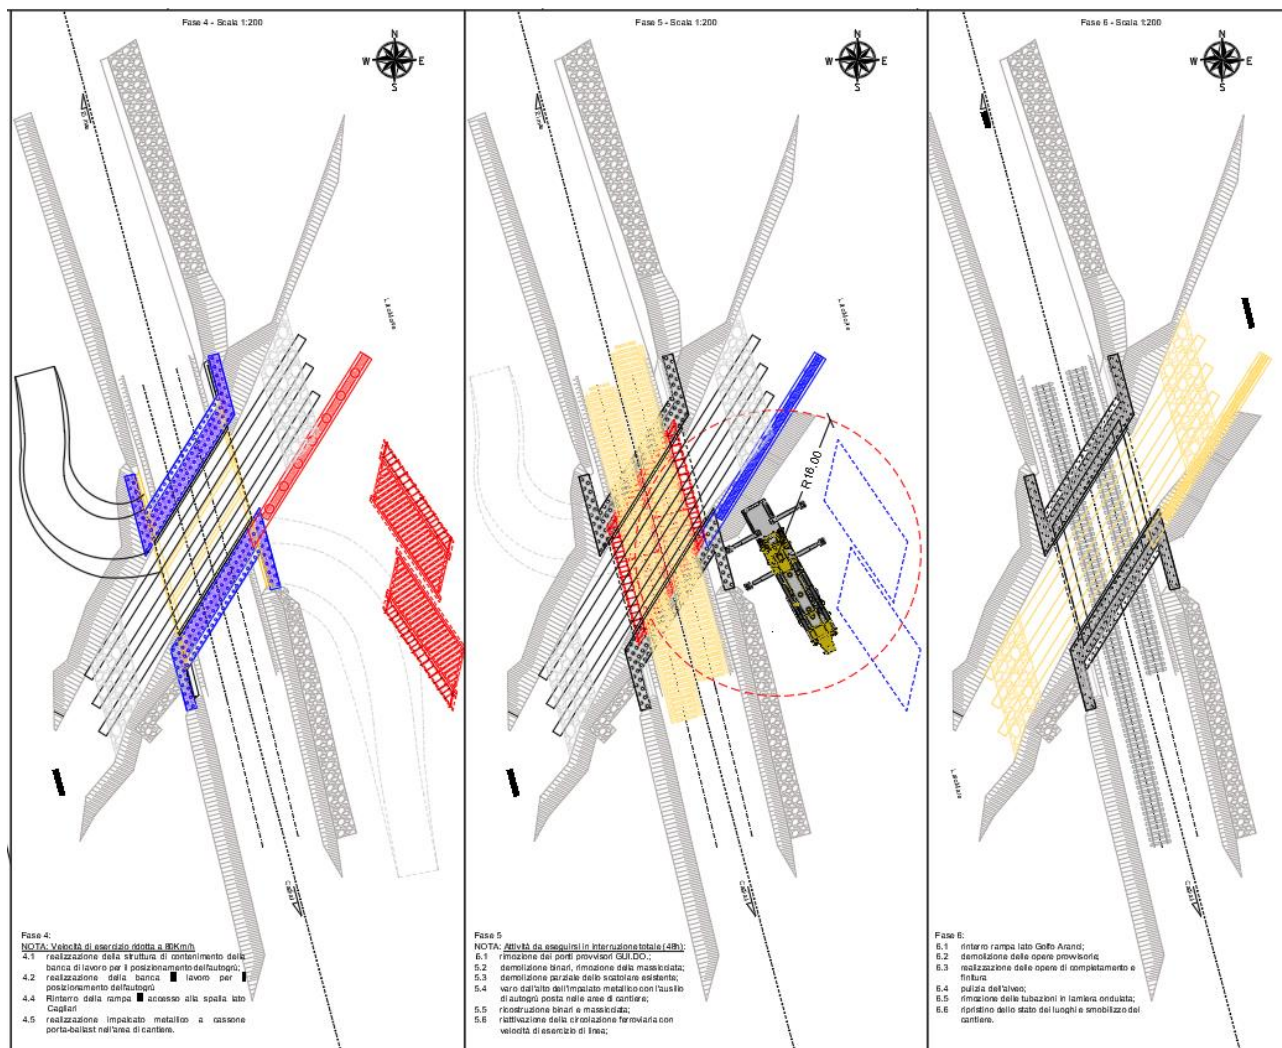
Stralcio planimetria fasi 4 -5-6.
